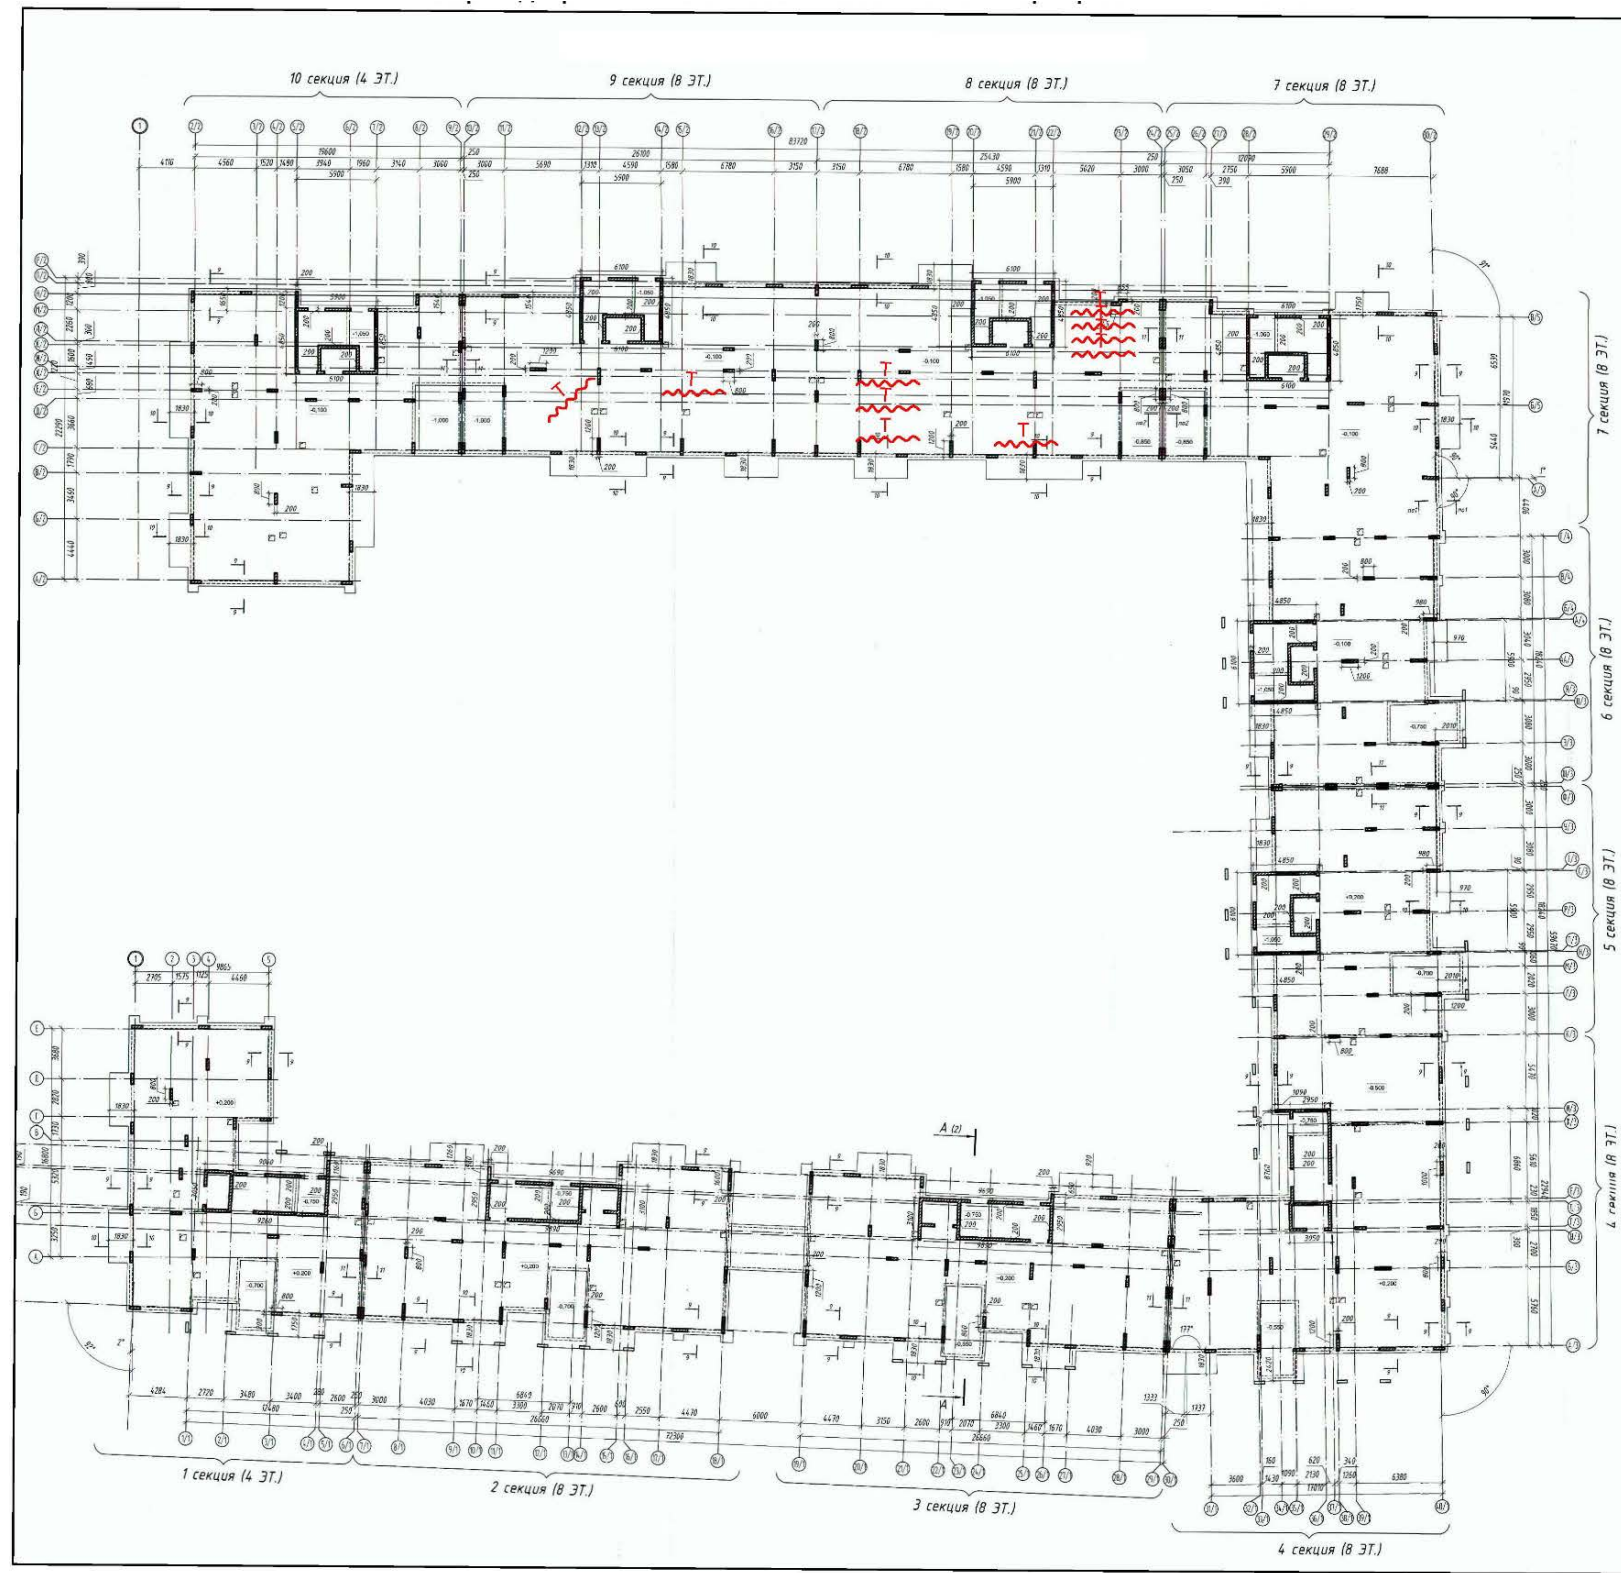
Карта дефектов нижней плоскости плиты перекрытия 2-го этажа
